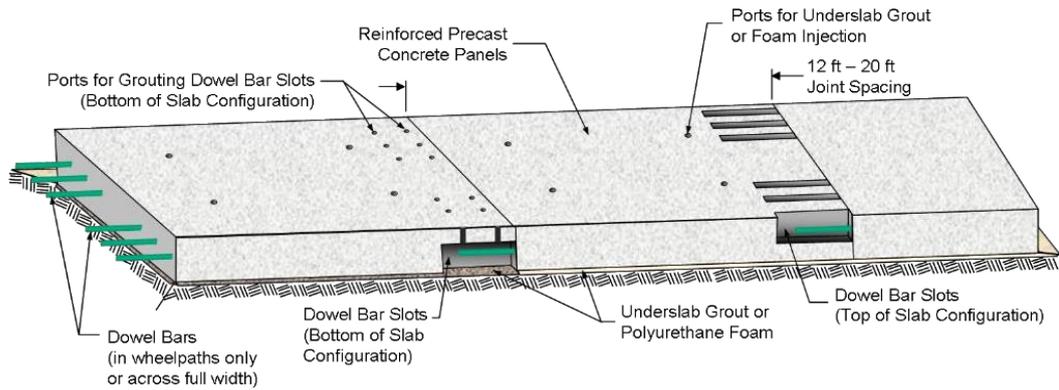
<https://www.thetranstecgroup.com/precast-pavement/precast-concrete-pavement-systems/>
